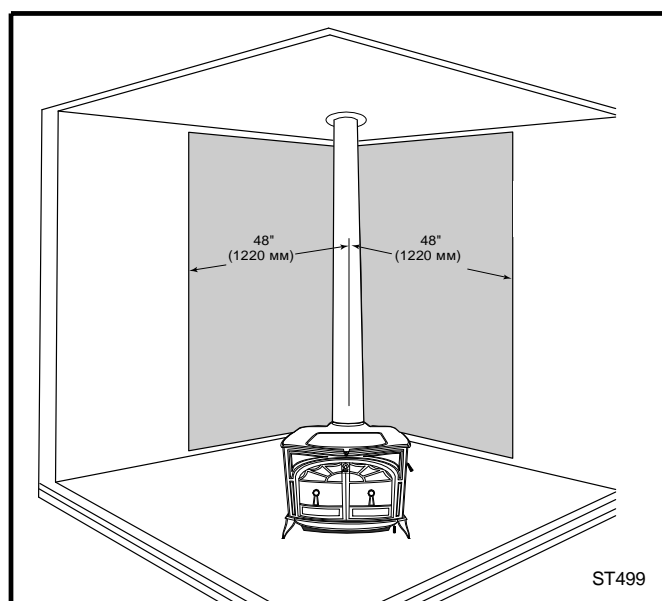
Установка в углу, вертикальный соединительный элемент, 2 защитных покрытия стены. Сокращенные расстояния. Защитные покрытия должны соединиться в углу.
